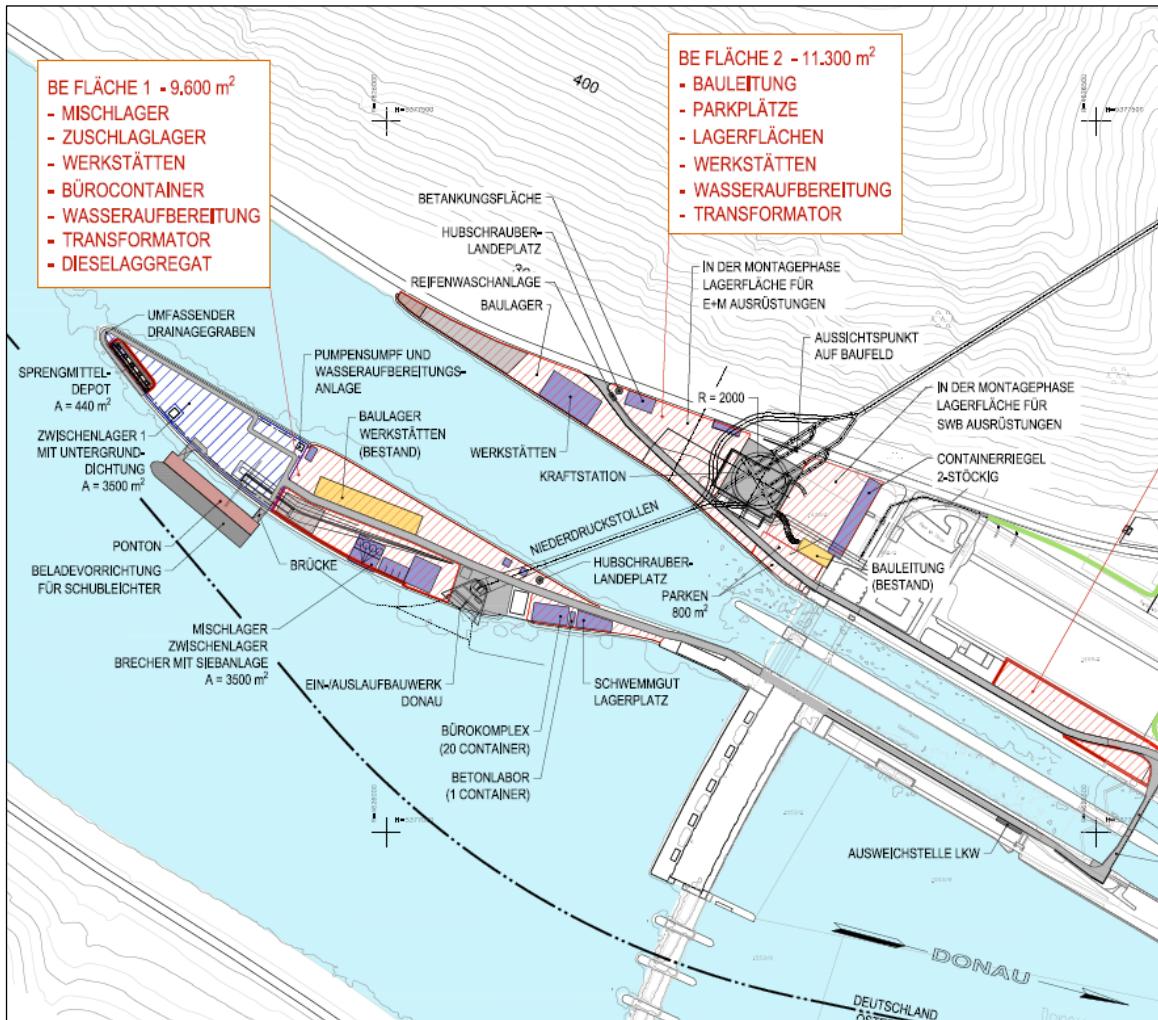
Übersicht Baustelleneinrichtungsfläche 1 – Bereich Donau
